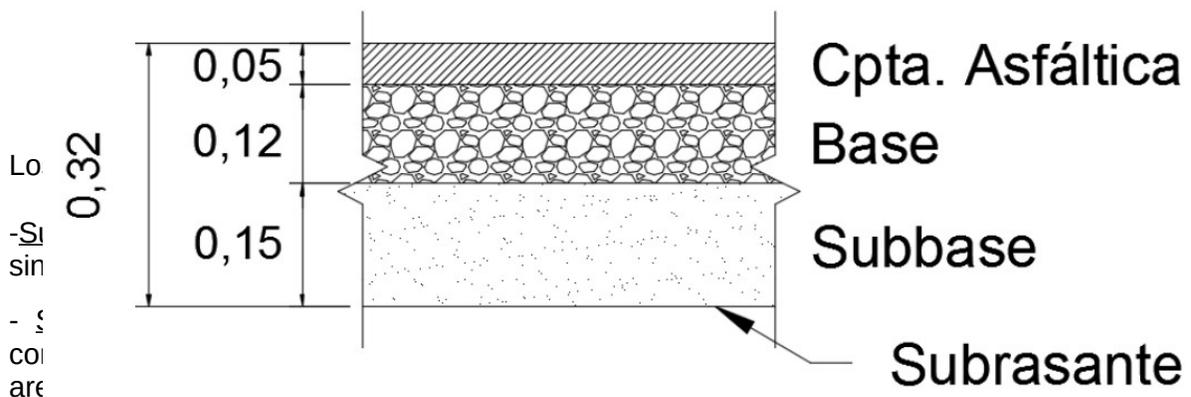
Paquete estructural de pavimentos flexibles.
